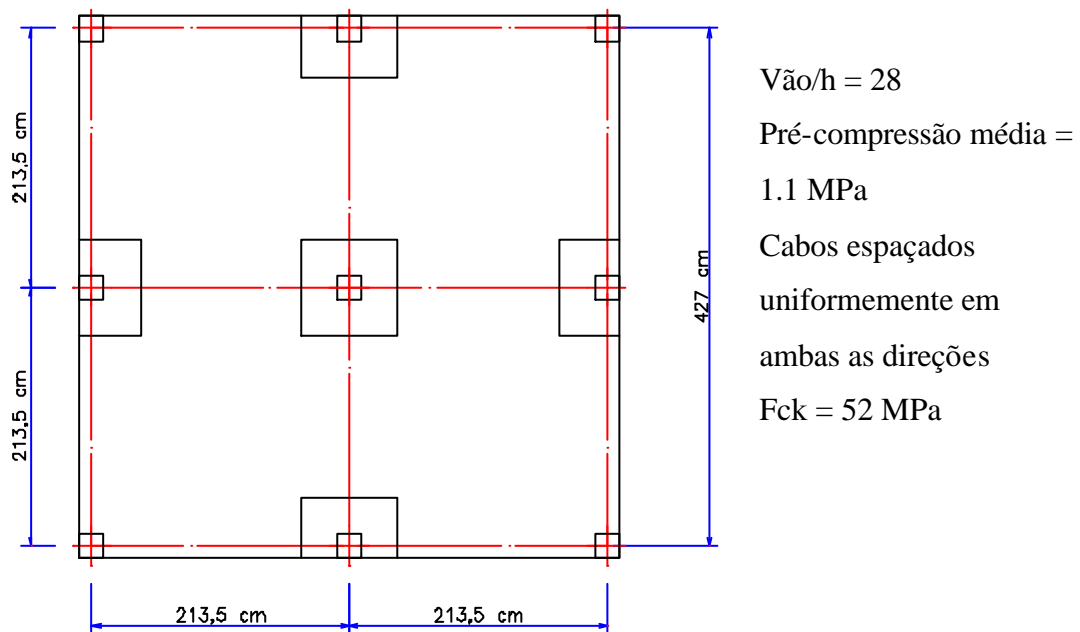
Laje Testada por Odello e Mehta – 1967
